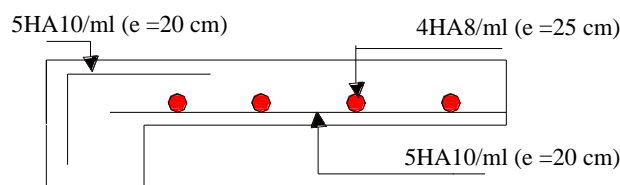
Schéma de ferrailage de la dalle pleine (D4)
